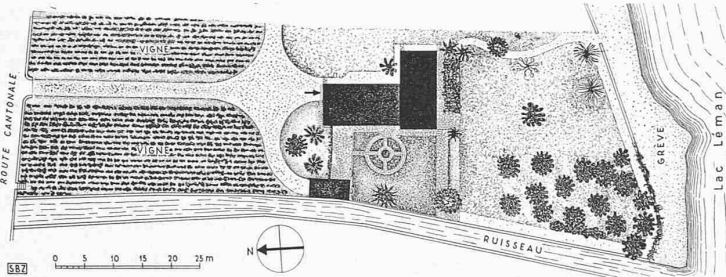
Plan de la situation au bord du Léman. — Echelle 1 : 1200
